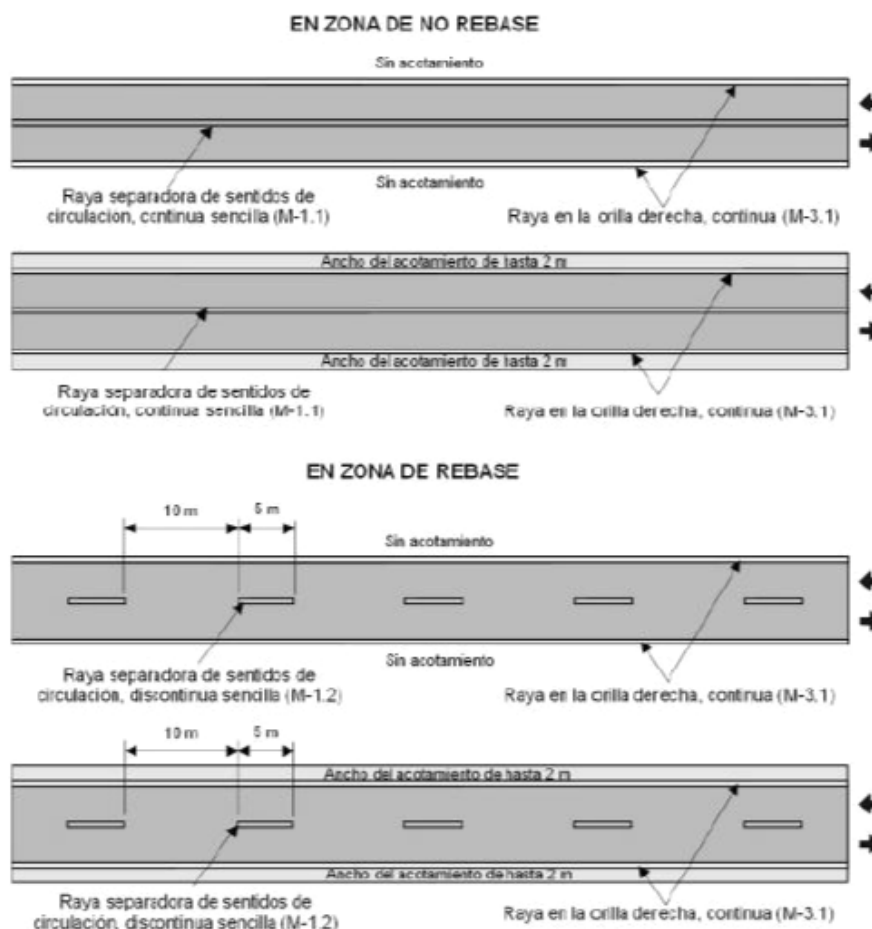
Marcas en el pavimento en carreteras con ancho de arroyo vial de hasta 6.5 m (Empleo de rayas M-1.1, M-1.2 y M-1.3)
